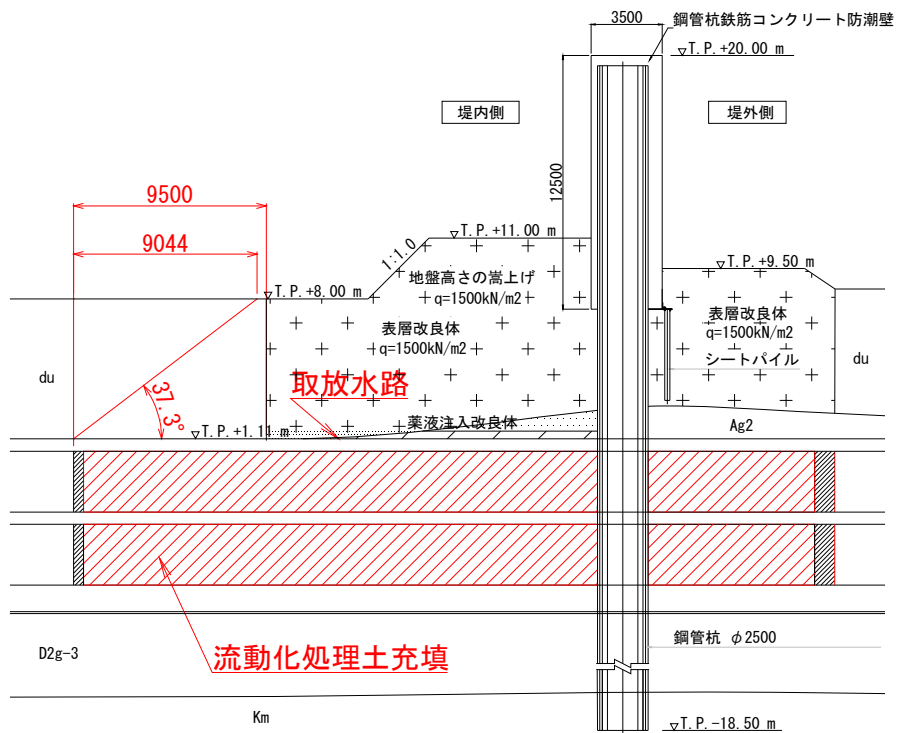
取放水路埋戻し位置断面図 (B-B断面)
